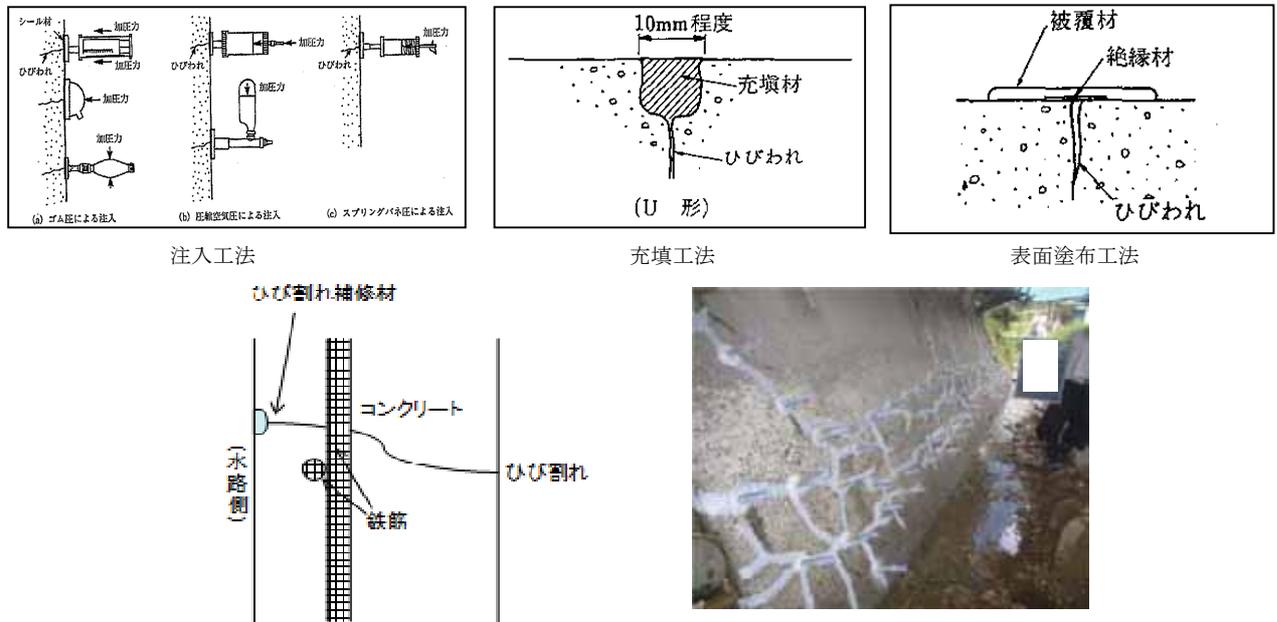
ひび割れ補修工法概念図(例)
